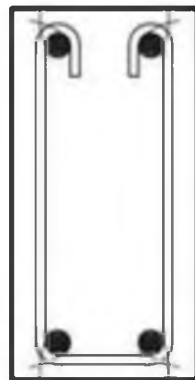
Связывание стержней композитной арматуры в каркасах:
